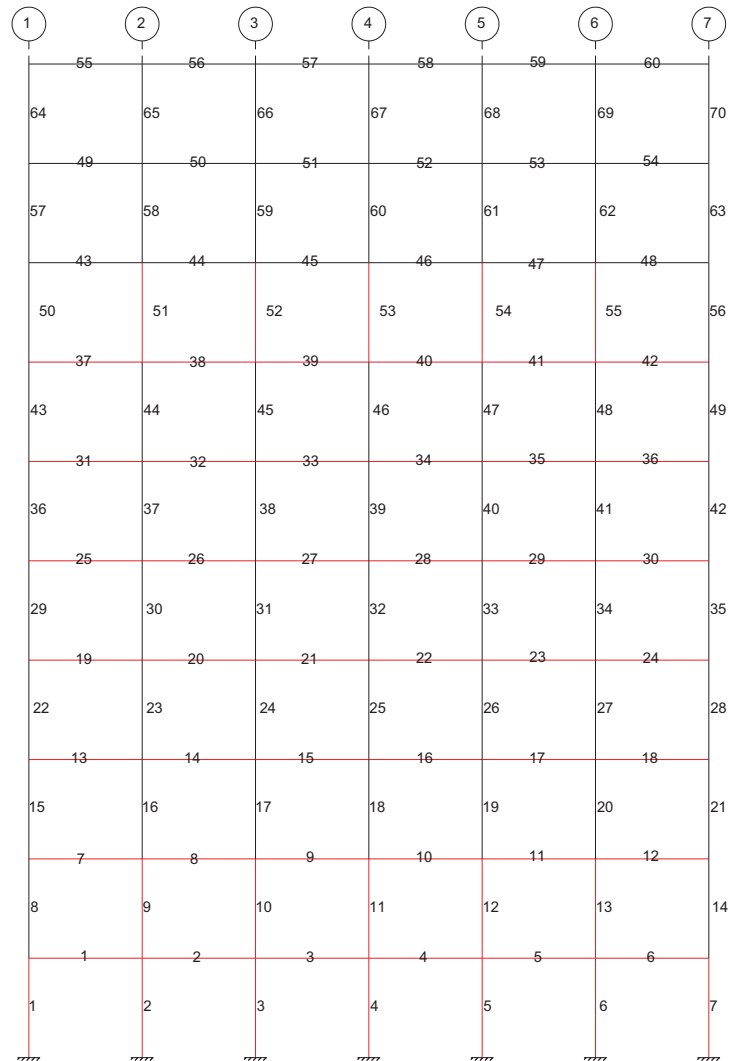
Columnas y vigas con mayor cantidad de daños. (Fuente: Propia)
